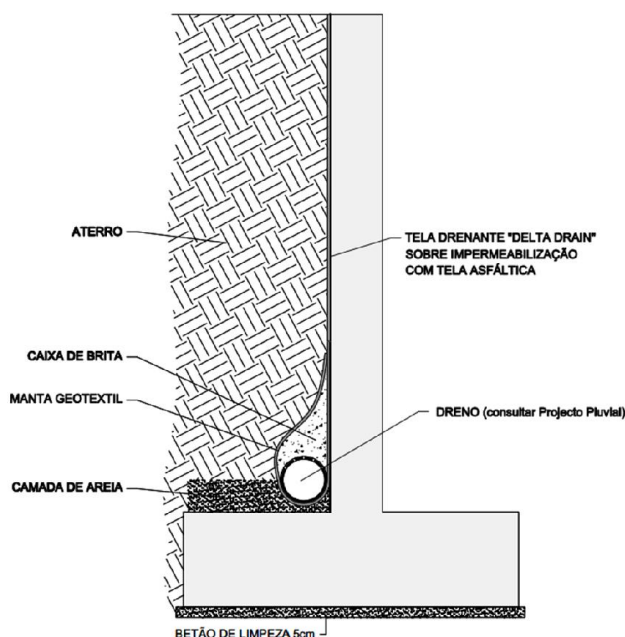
Pormenor tipo de drenagem do muro (Marques, 2011).
